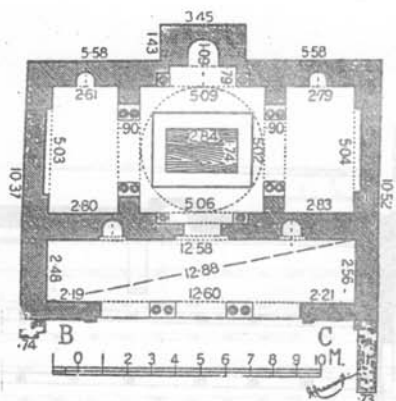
مسقط وقطاع لمسجد ومشهد الجيوشي عن Creswell
